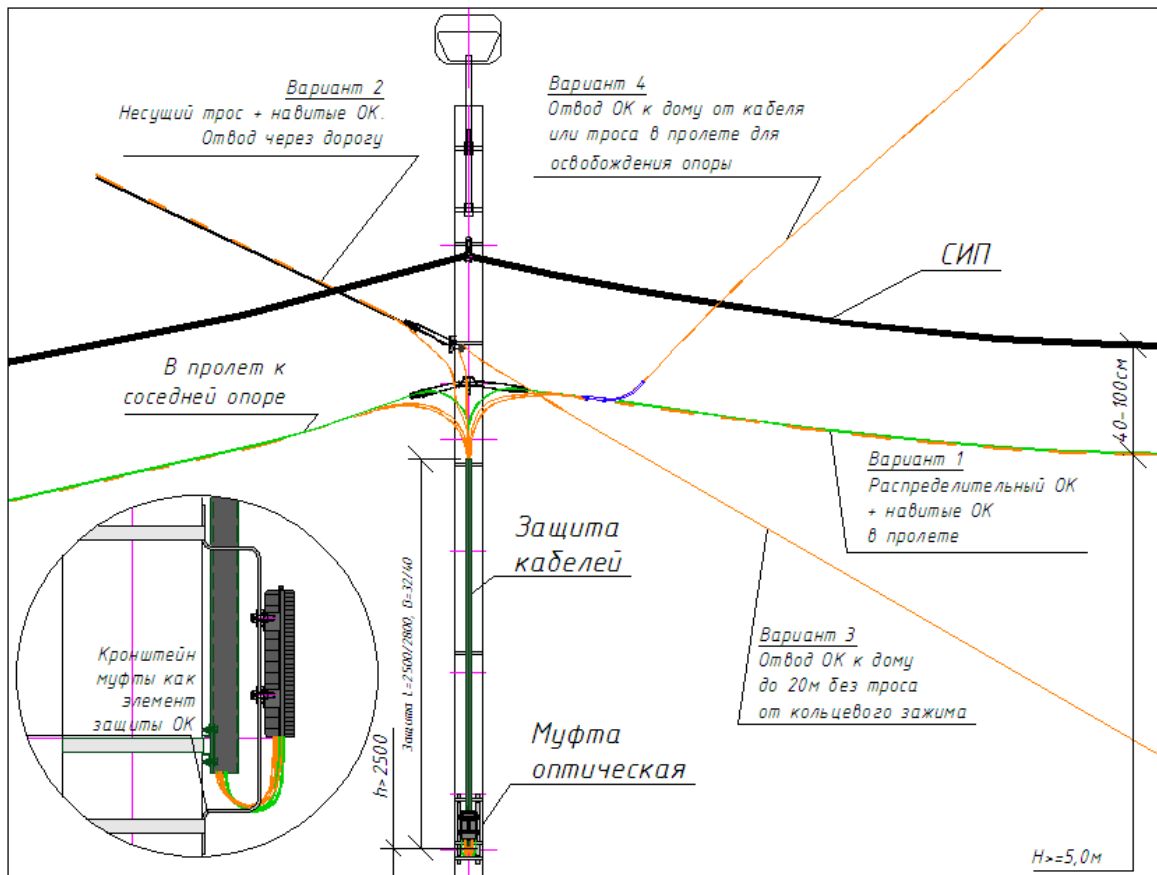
Схема прокладки ВОК по опорам силовой/осветительной сети
